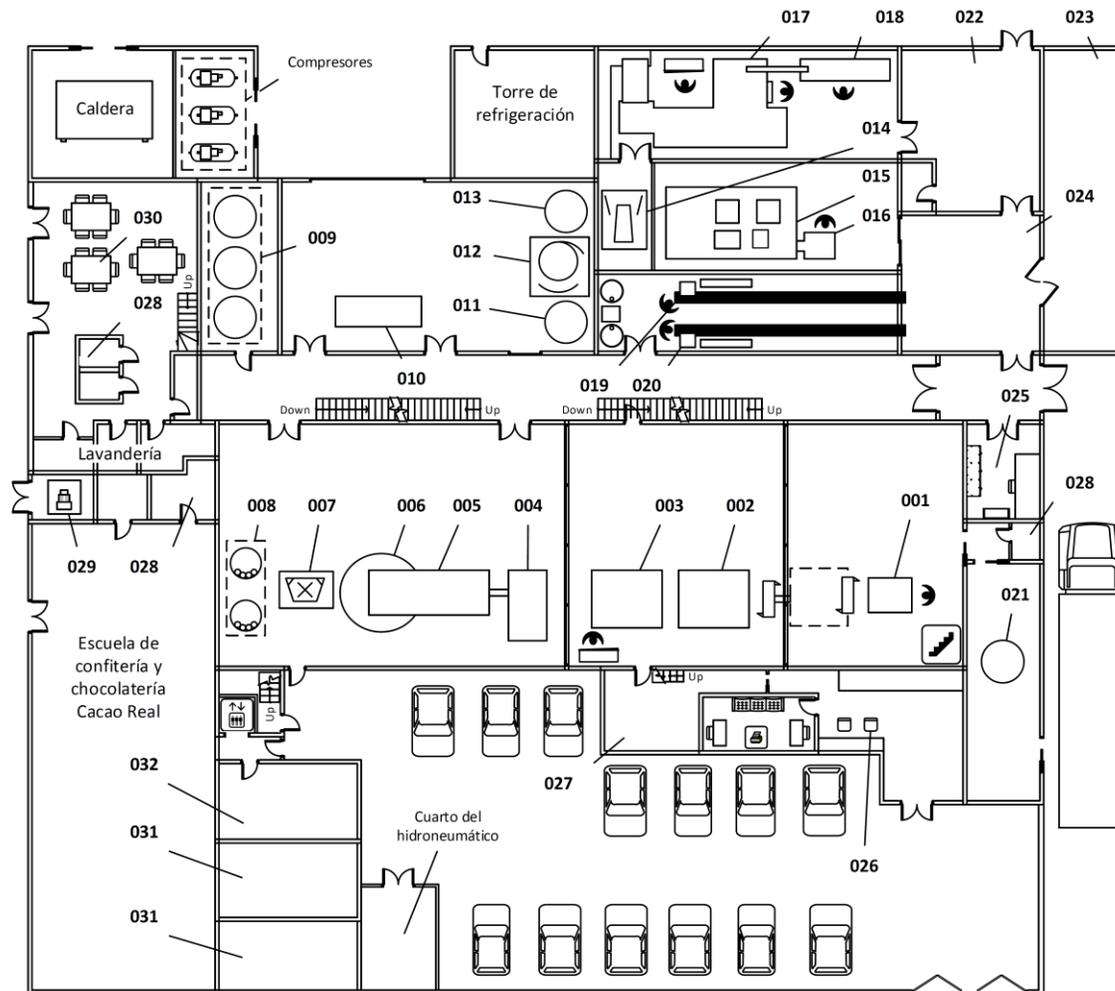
3: Disposición de equipos y maquinaria en áreas de planta.
